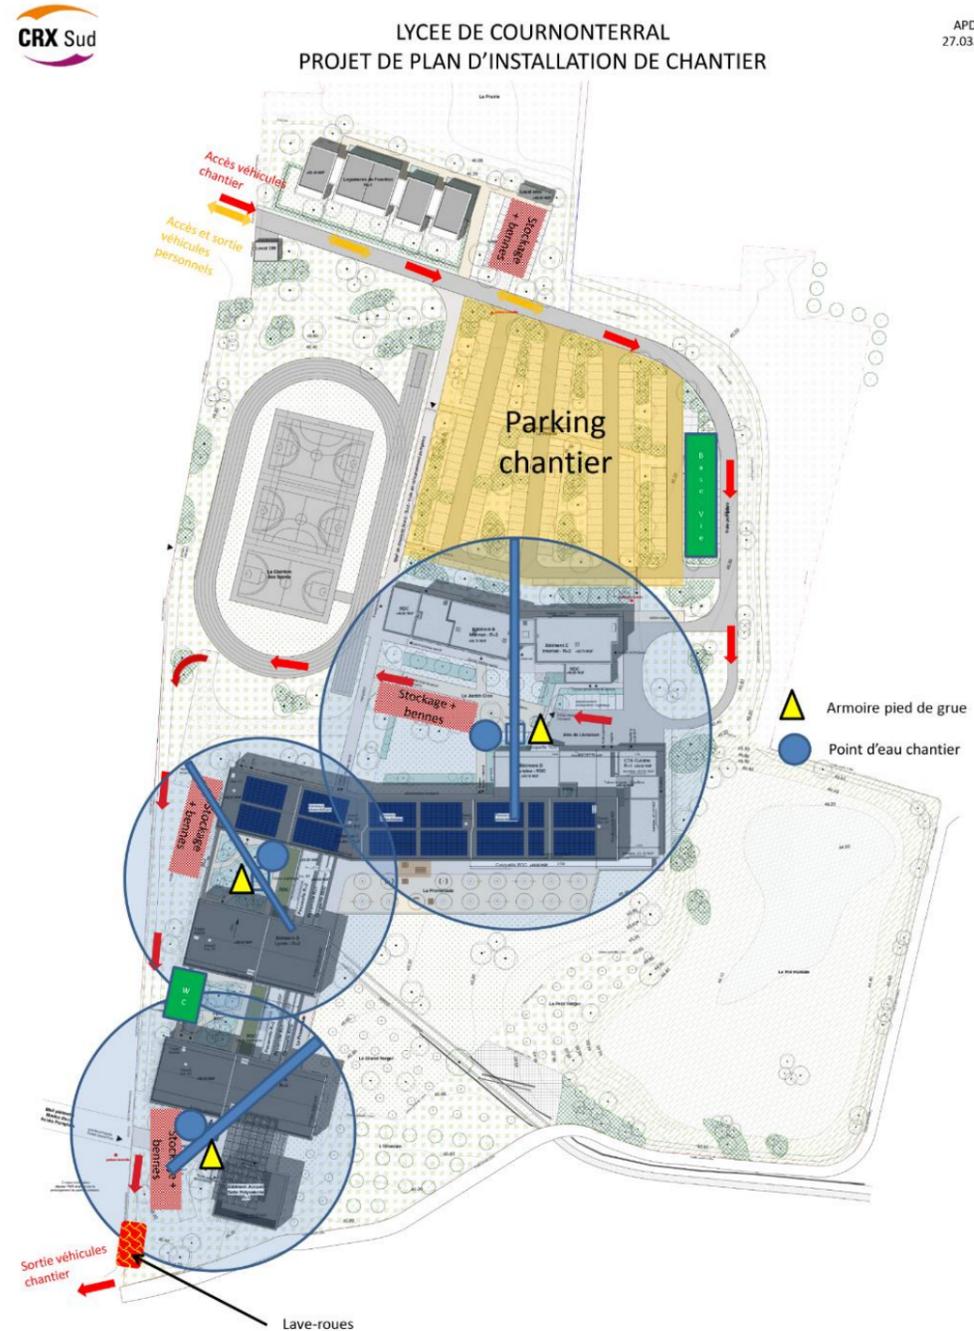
Plan d'installation de chantier (Source : APD projet Lycée Courmonterral, BPA avril 2022)
